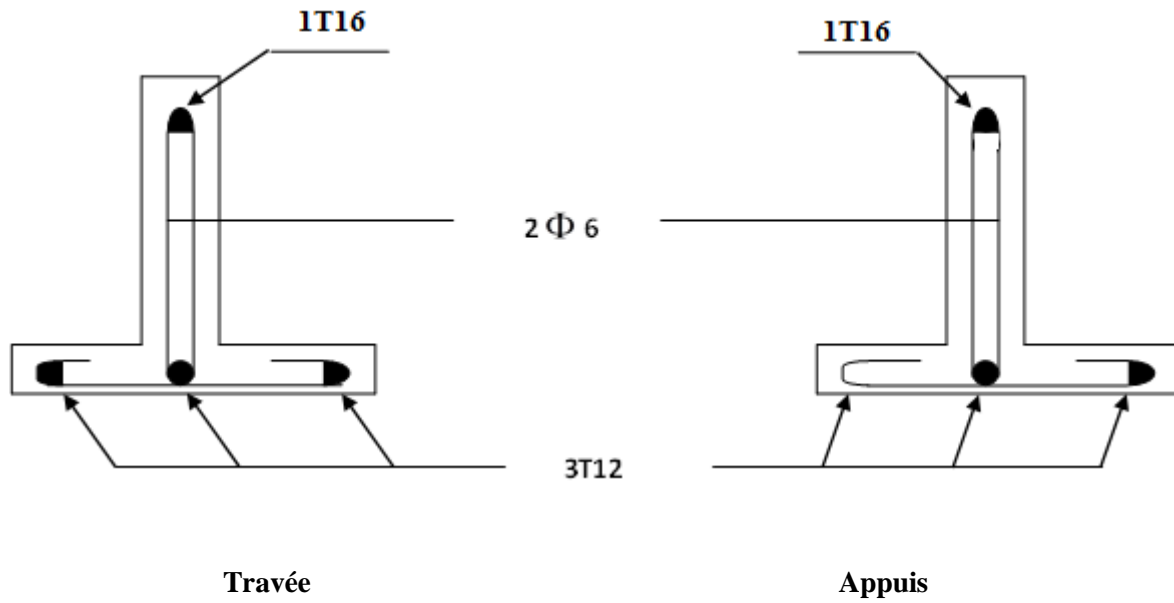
Disposition constructive des armatures des poutrelles à 6 travées.
